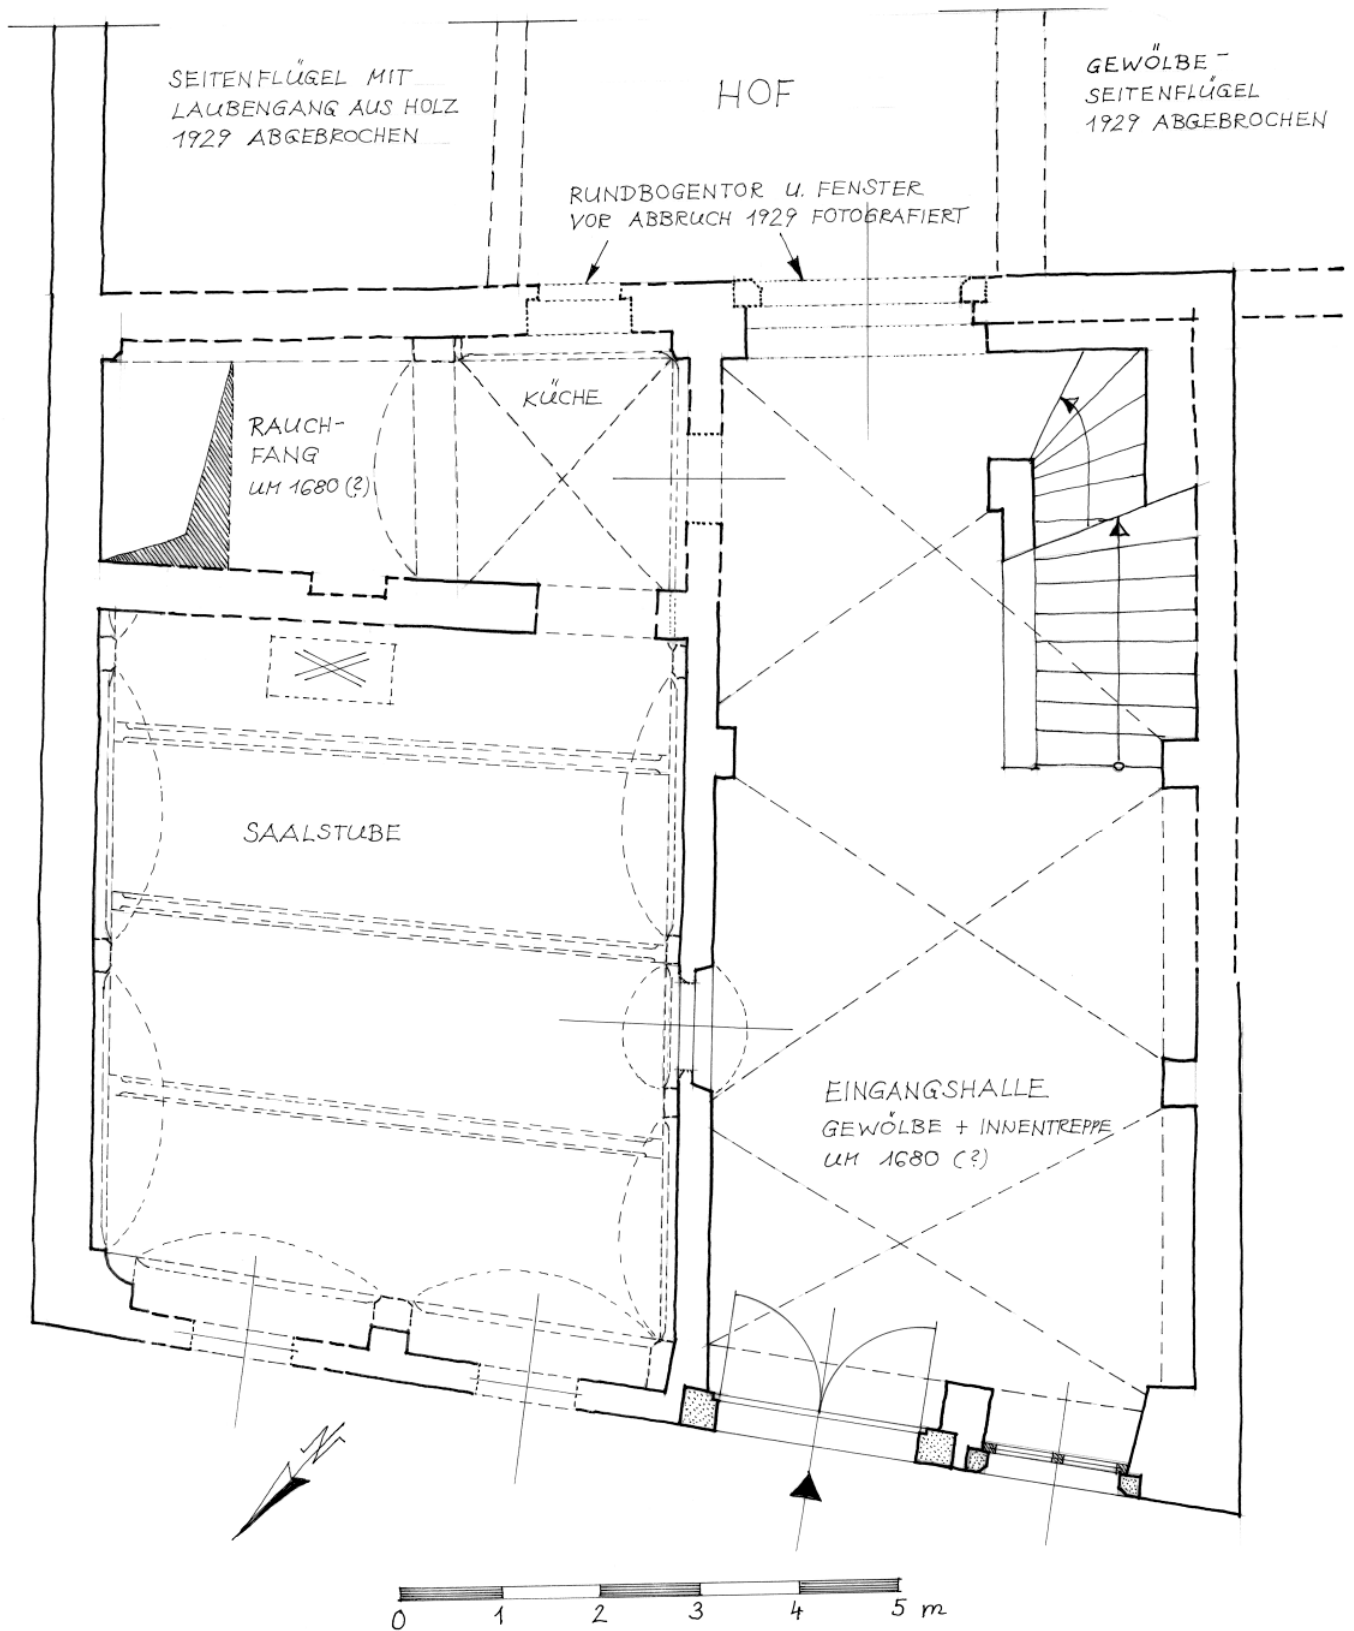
Görnische Gasse 7, Grundriss Erdgeschoss zeichn. Rekonstruktion
